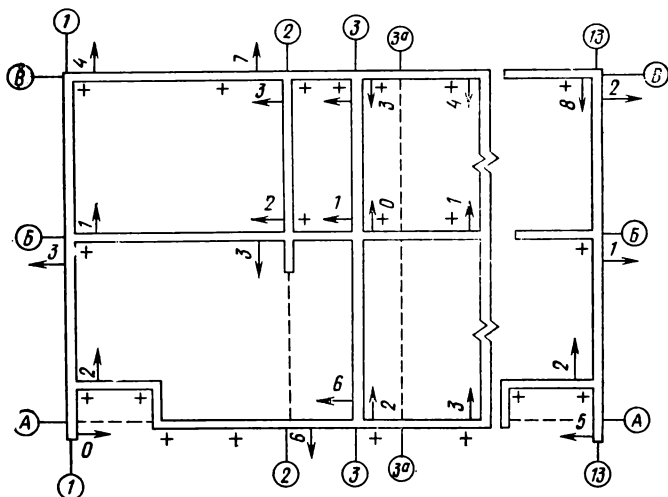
Исполнительная схема фундаментных блоков крупнопанельного жилого дома
